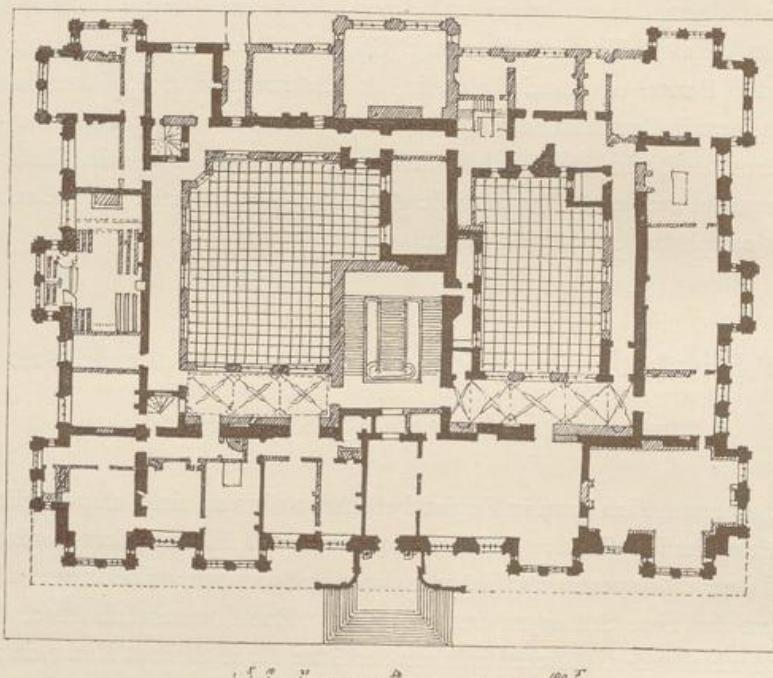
Longleat House. Grundriss. (n. Britton.)
